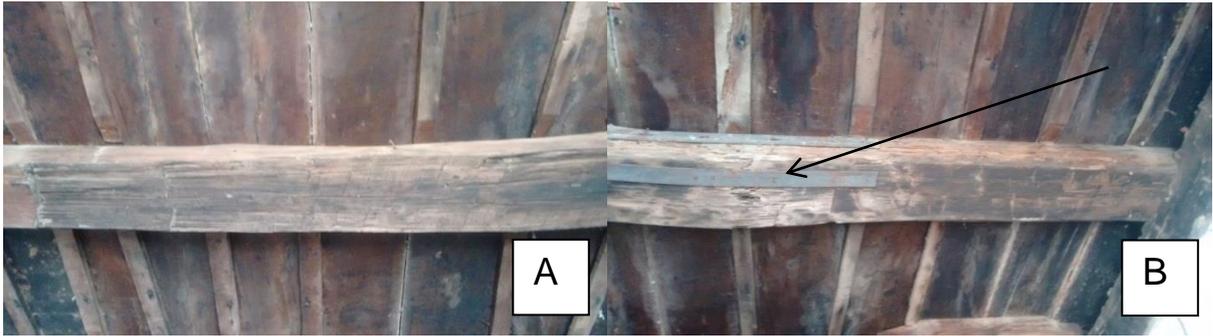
Edificação 14: A – Barrote, B – Barrote com ligas metálicas (seta indicativa).
